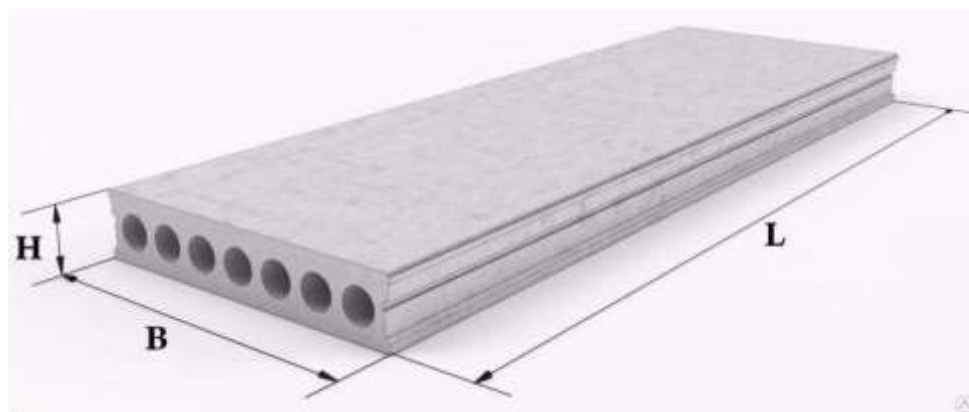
Плита перекрытия ПК 60.15-12,5
